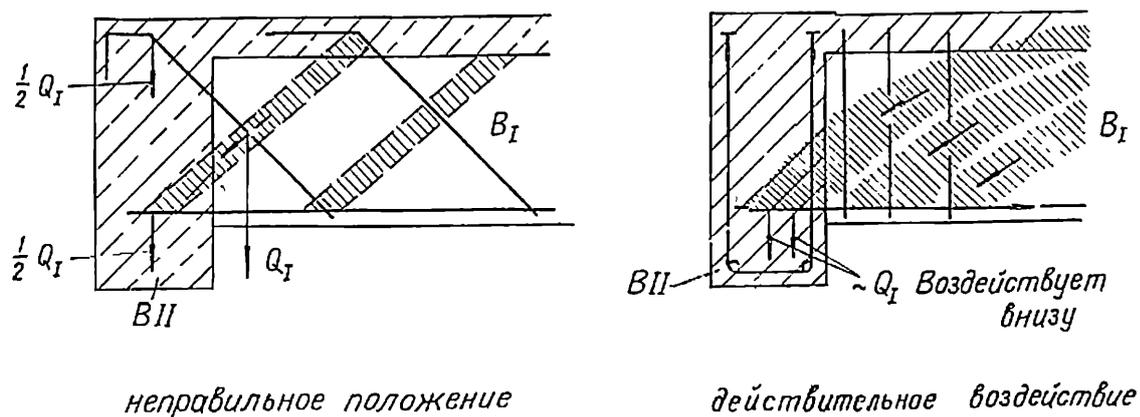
1. Железобетонные балки передают нагрузки также и при не прямом опирании преимущественно через сжатые раскосы
